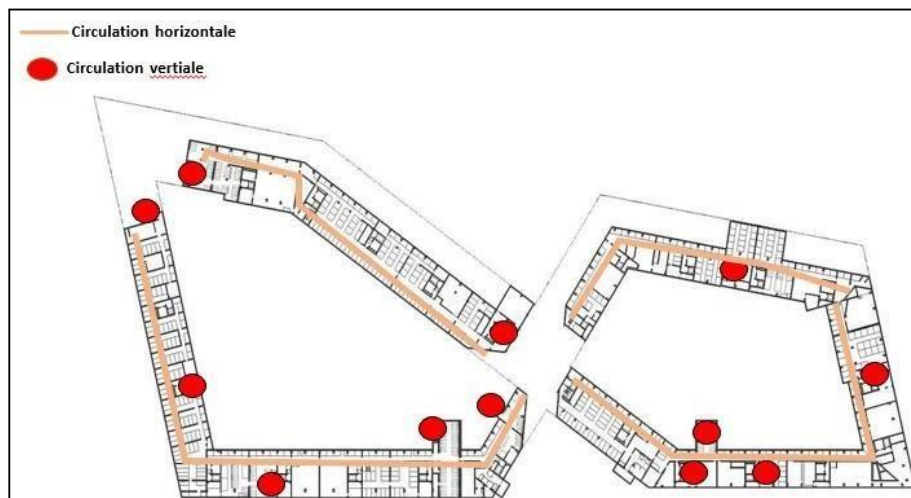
plan de sous-sol, source : <https://www.archdaily.com/>
